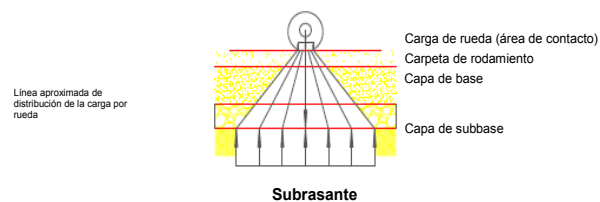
Distribución de carga de una rueda en el pavimento flexible
